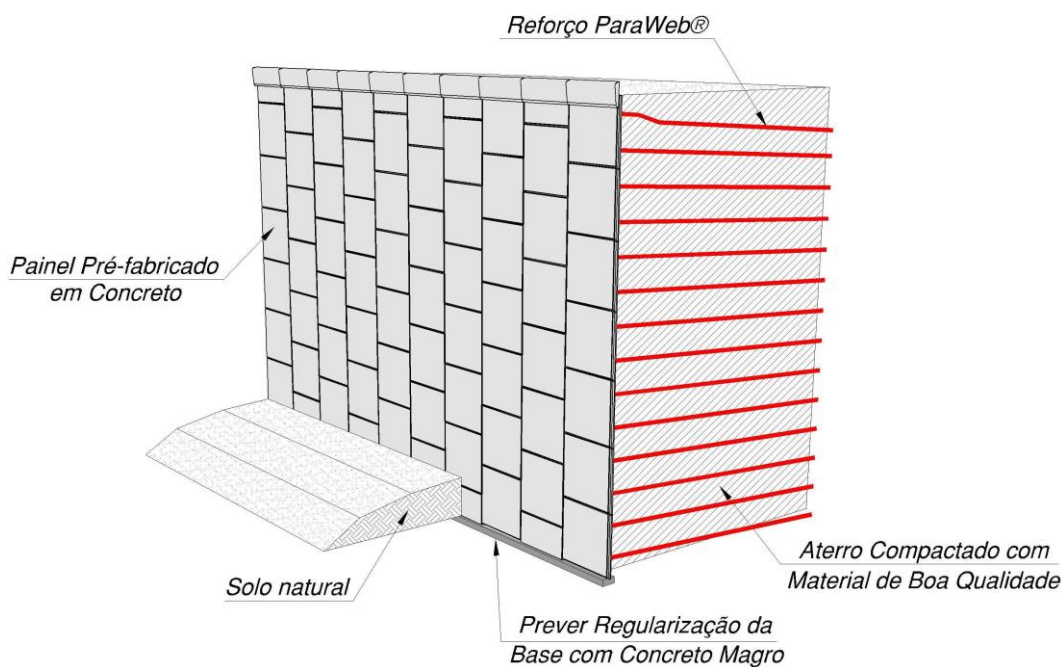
SISTEMA MACFORCE®
